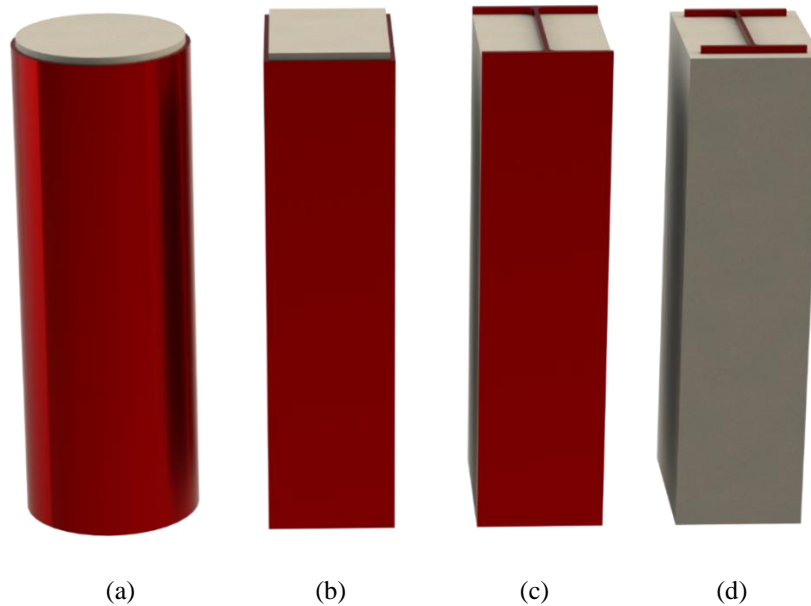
Pilares mistos de aço e concreto: (a) pilar misto preenchido com concreto de seção circular; (b) pilar misto preenchido com concreto de seção retangular; (c) pilar misto parcialmente revestido com concreto; (d) pilar misto revestido com concreto
